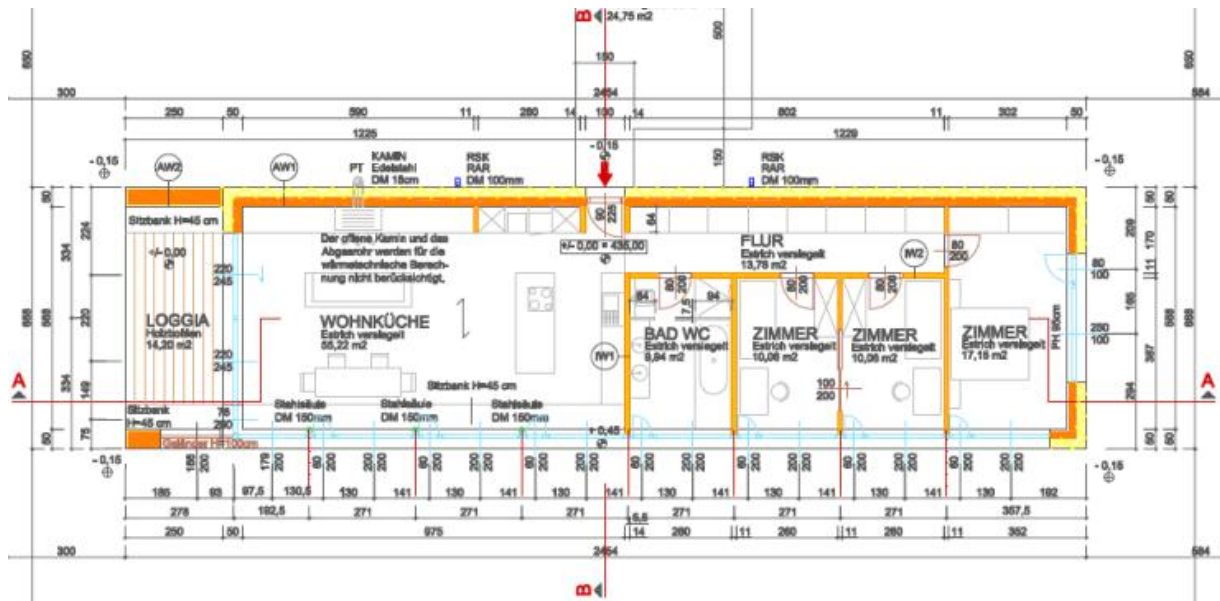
Grundriss Modellgebäude in Massivbauweise
